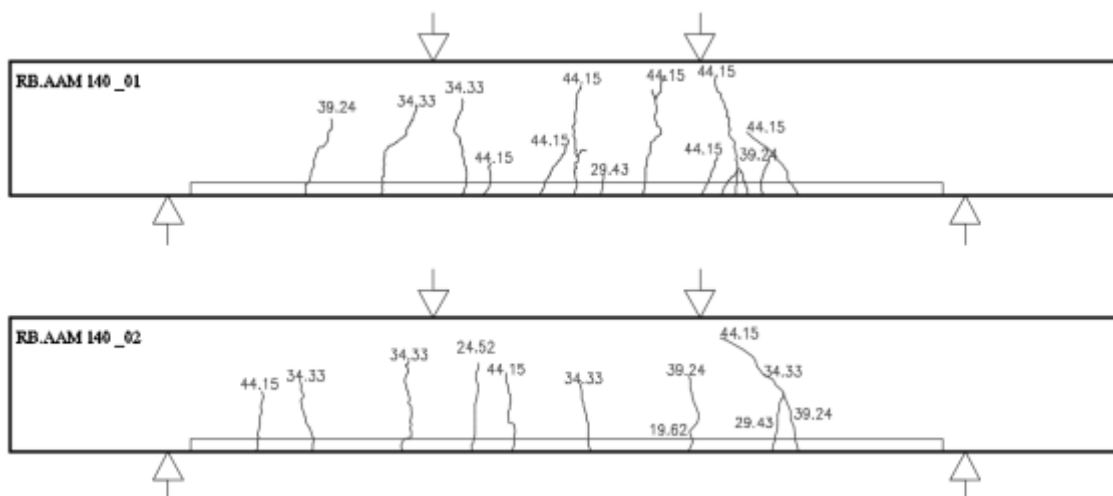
Mapeamento das fissuras- vigas de referência.
